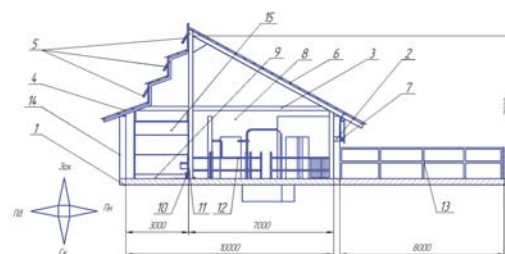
Поперечний переріз тваринницької будівлі на 20 корів з поголів'ям молодняку: 1 – підлога бетонна; 2 – стіни (блоки з пінобетону); 3 – каркас з металоконструкцій; 4 – покрівля даху каскадного типу; 5 – клапан вентиляційний; 6 – покрівля даху з профнастилу; 7 – штори бокові вентиляційні; 8 – стіна торцева із боків з пінобетону; 9 – галерея; 10 – кормовий стіл; 11 – огороження кормового столу; 12 – огороження секцій для безприв'язного утримання тварин; 13 – огороження вигульних майданчиків; 14 – стіна з полікарбонату прозорого; 15 – ворота-ролети
